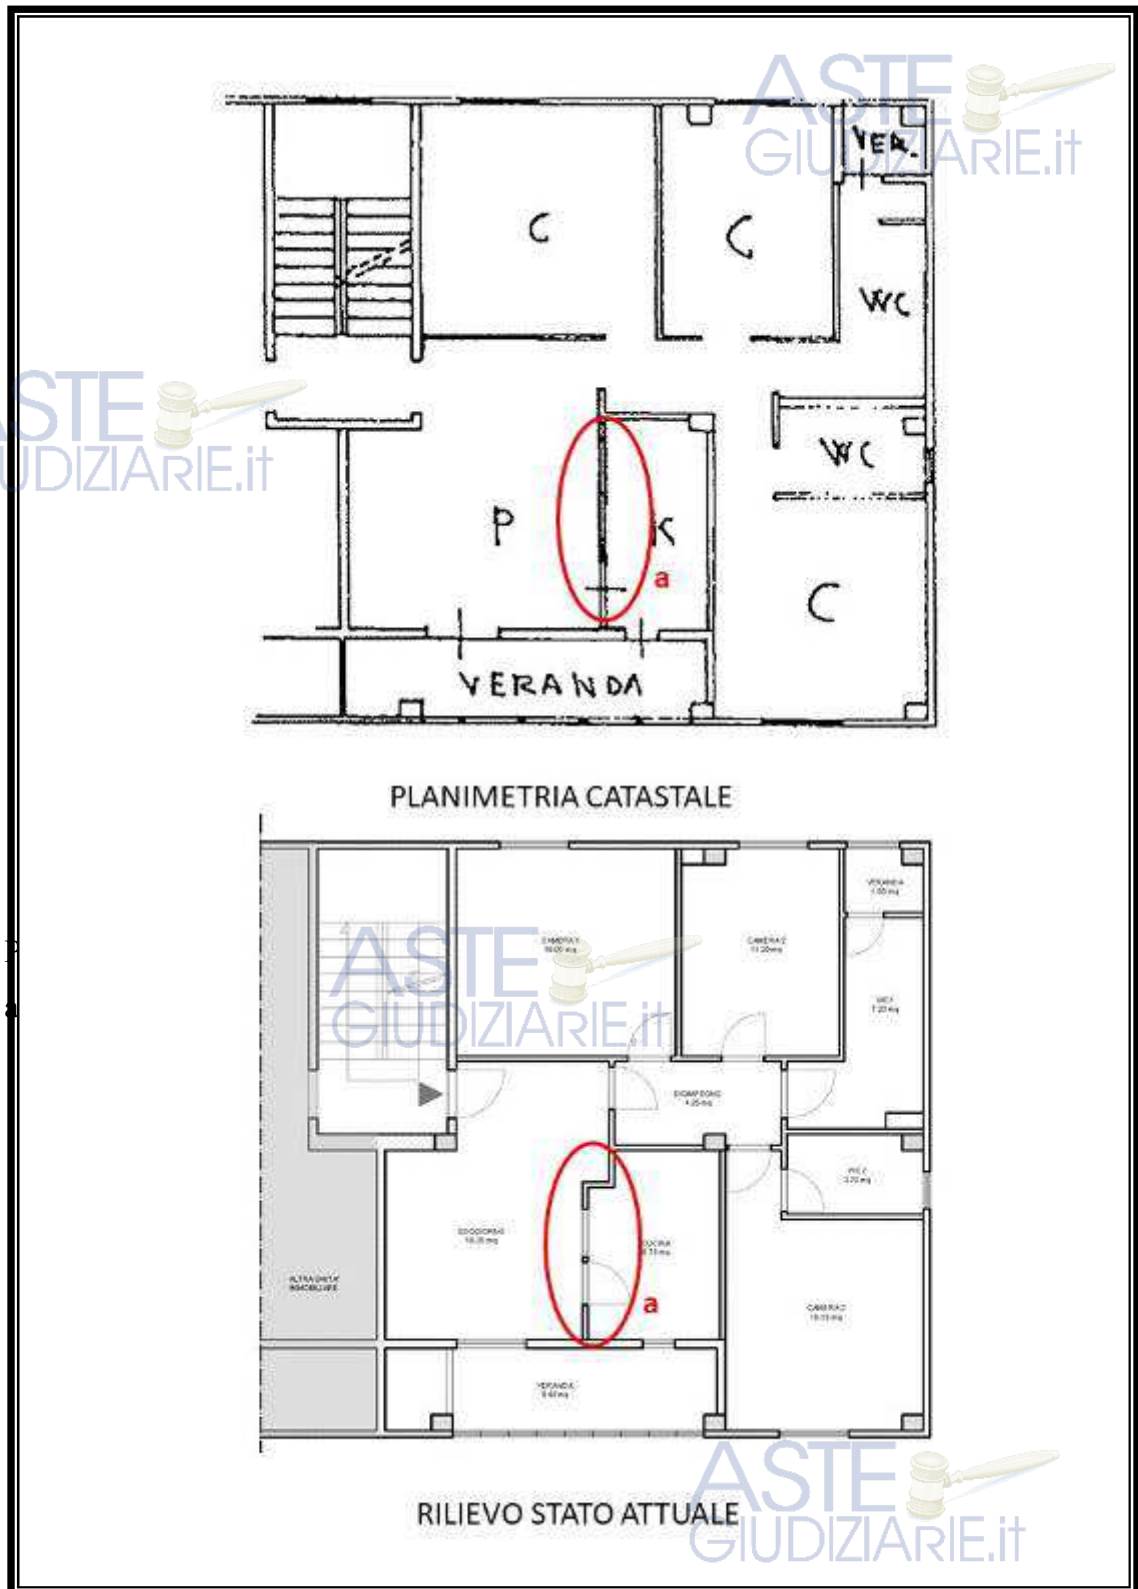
Confronto tra Planimetria catastale e Rilievo stato attuale
